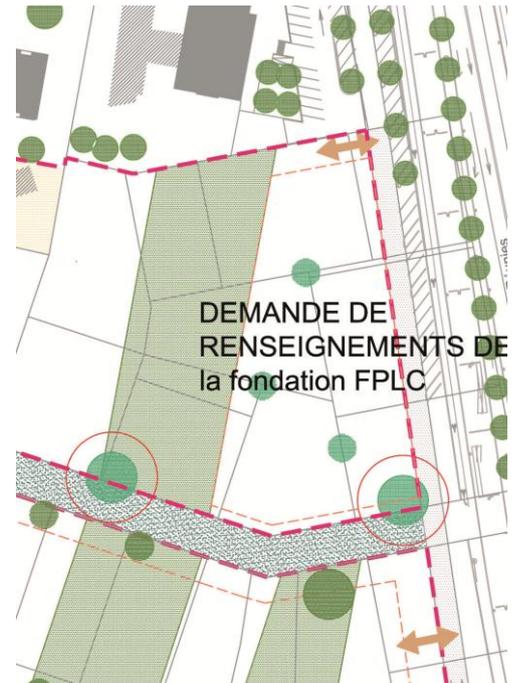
Plan des parcelles de KM&S pour la Fondation FPLC superposé au PDQ
